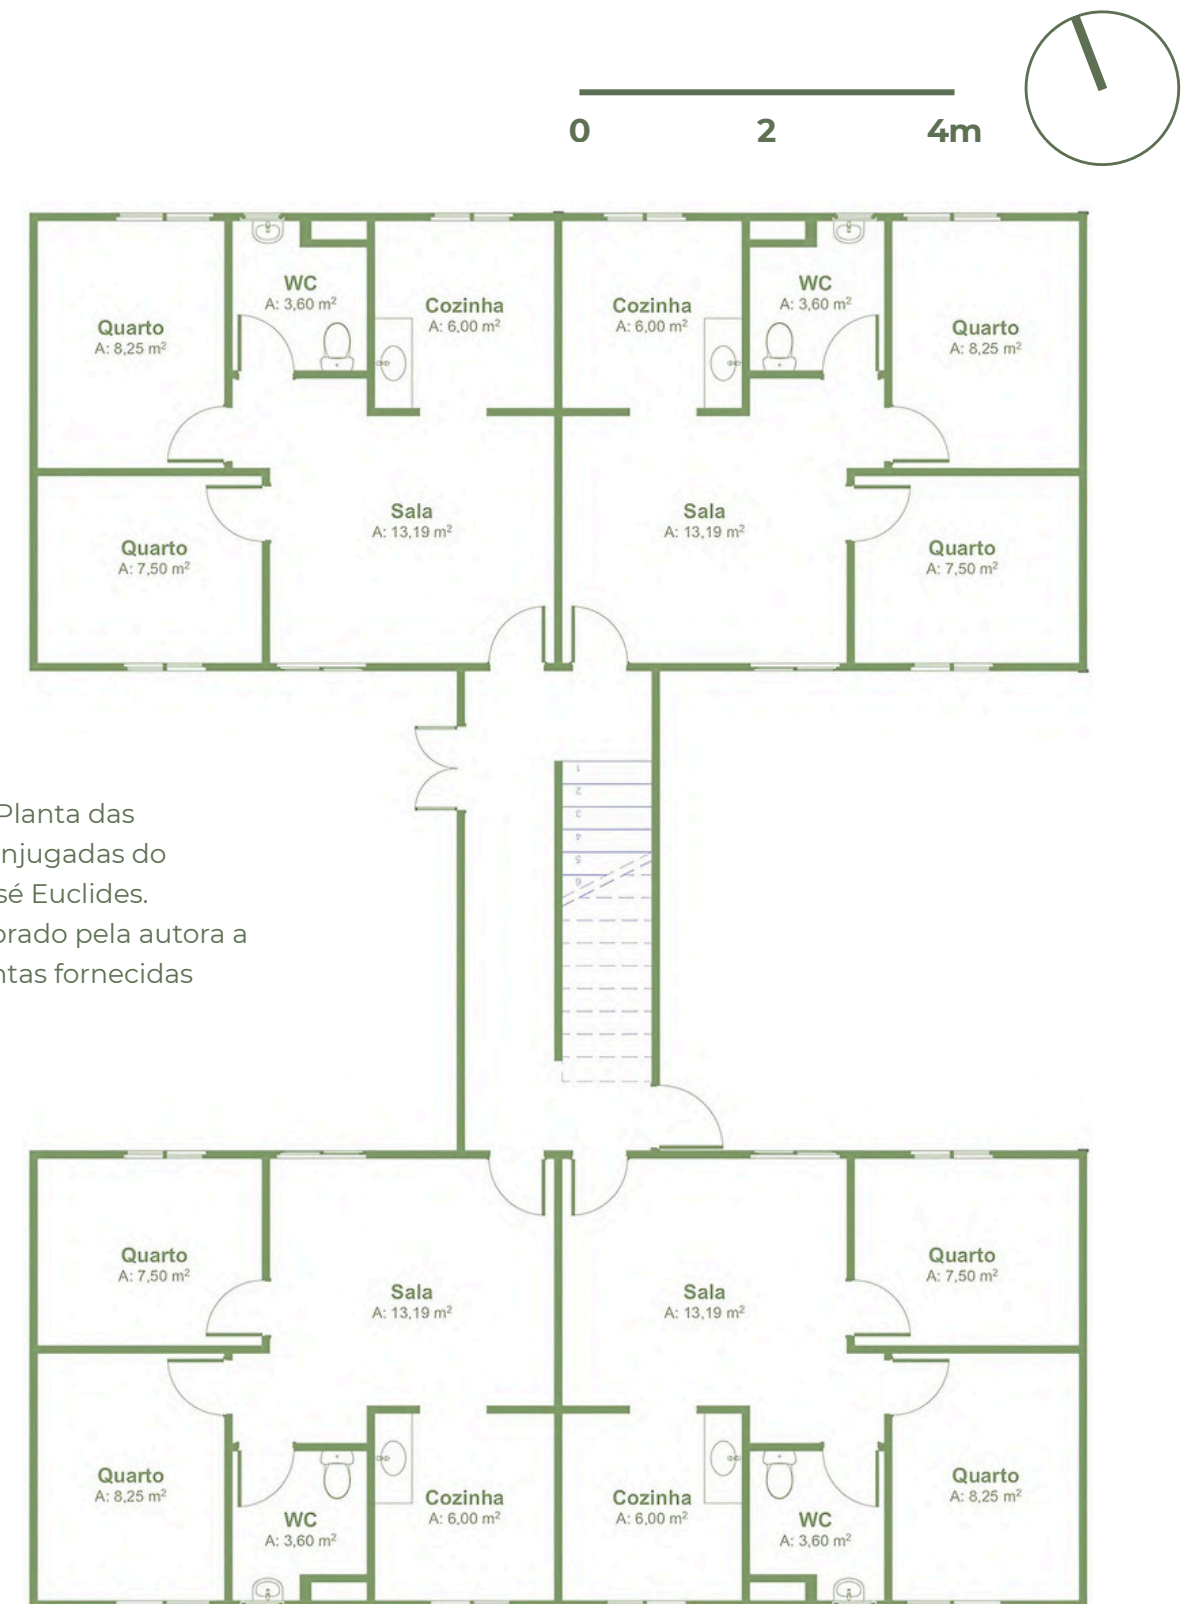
Planta das unidades conjugadas do conjunto José Euclides.
